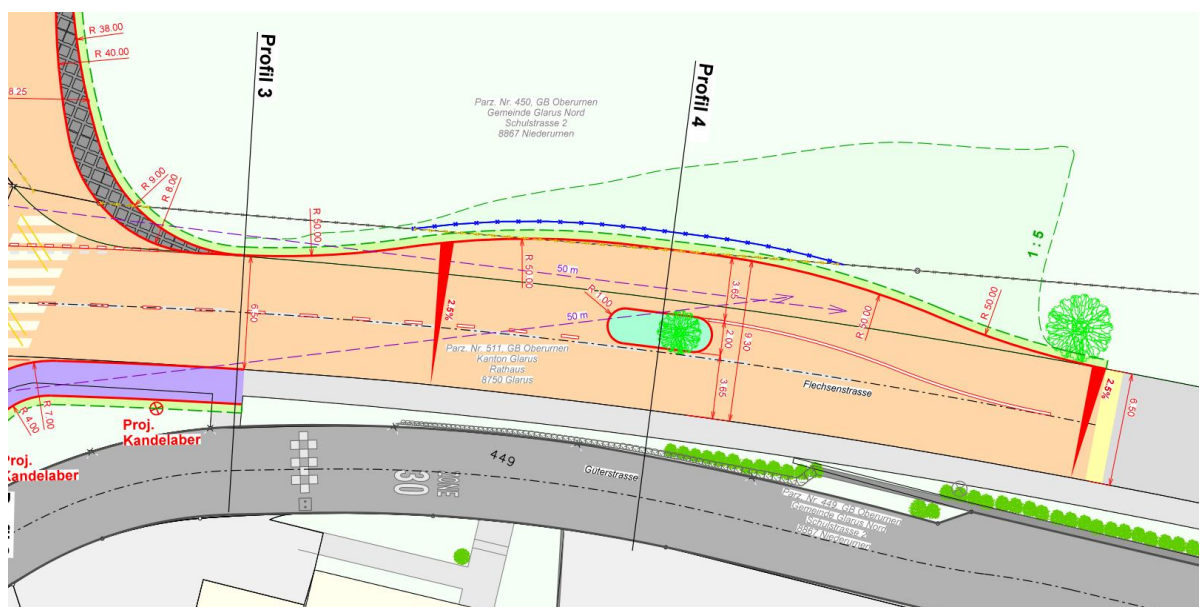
Situationsplan Ausschnitt Eingangstor
